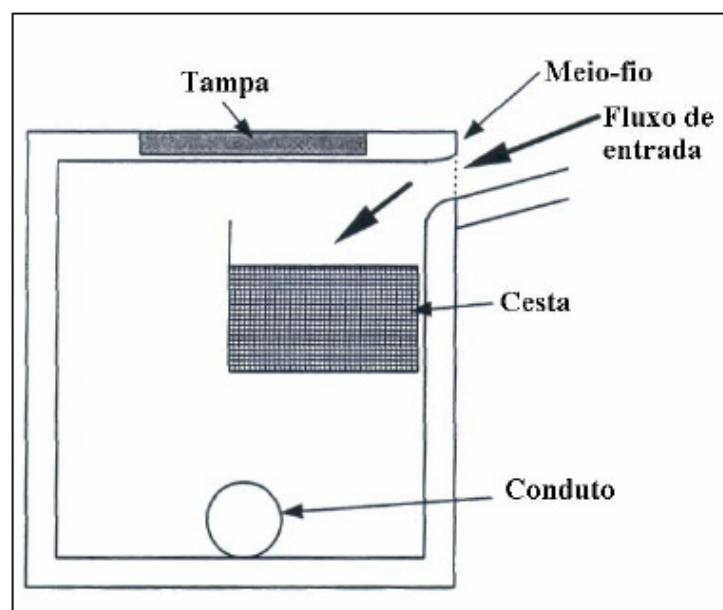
Melhores arranjos de estudo de estruturas autolimpantes.
